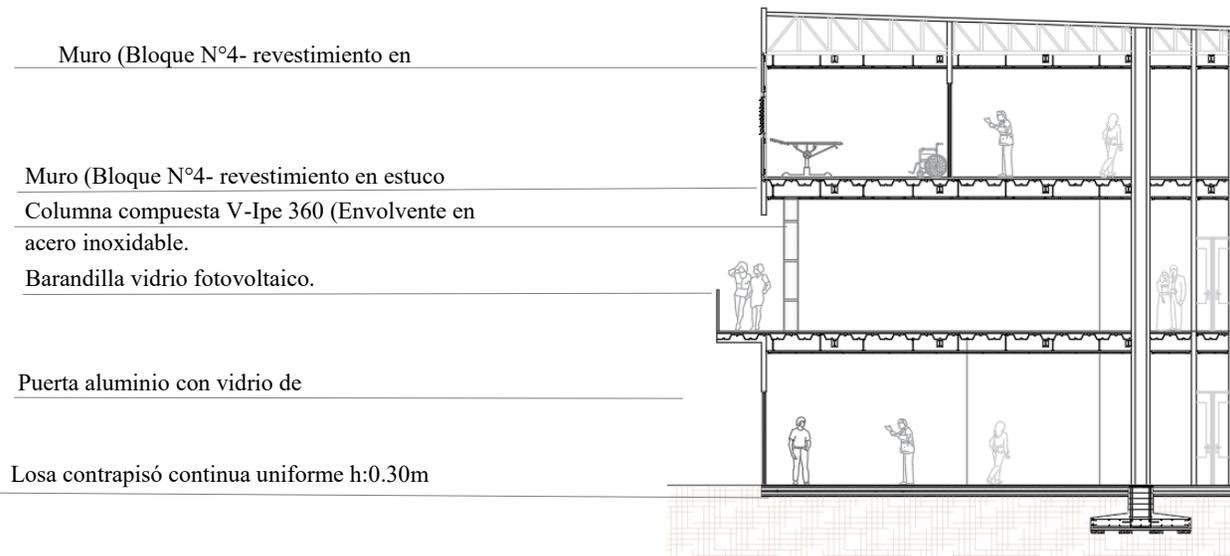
Detalle constructivo Corte Fachada/ Materialidad.
